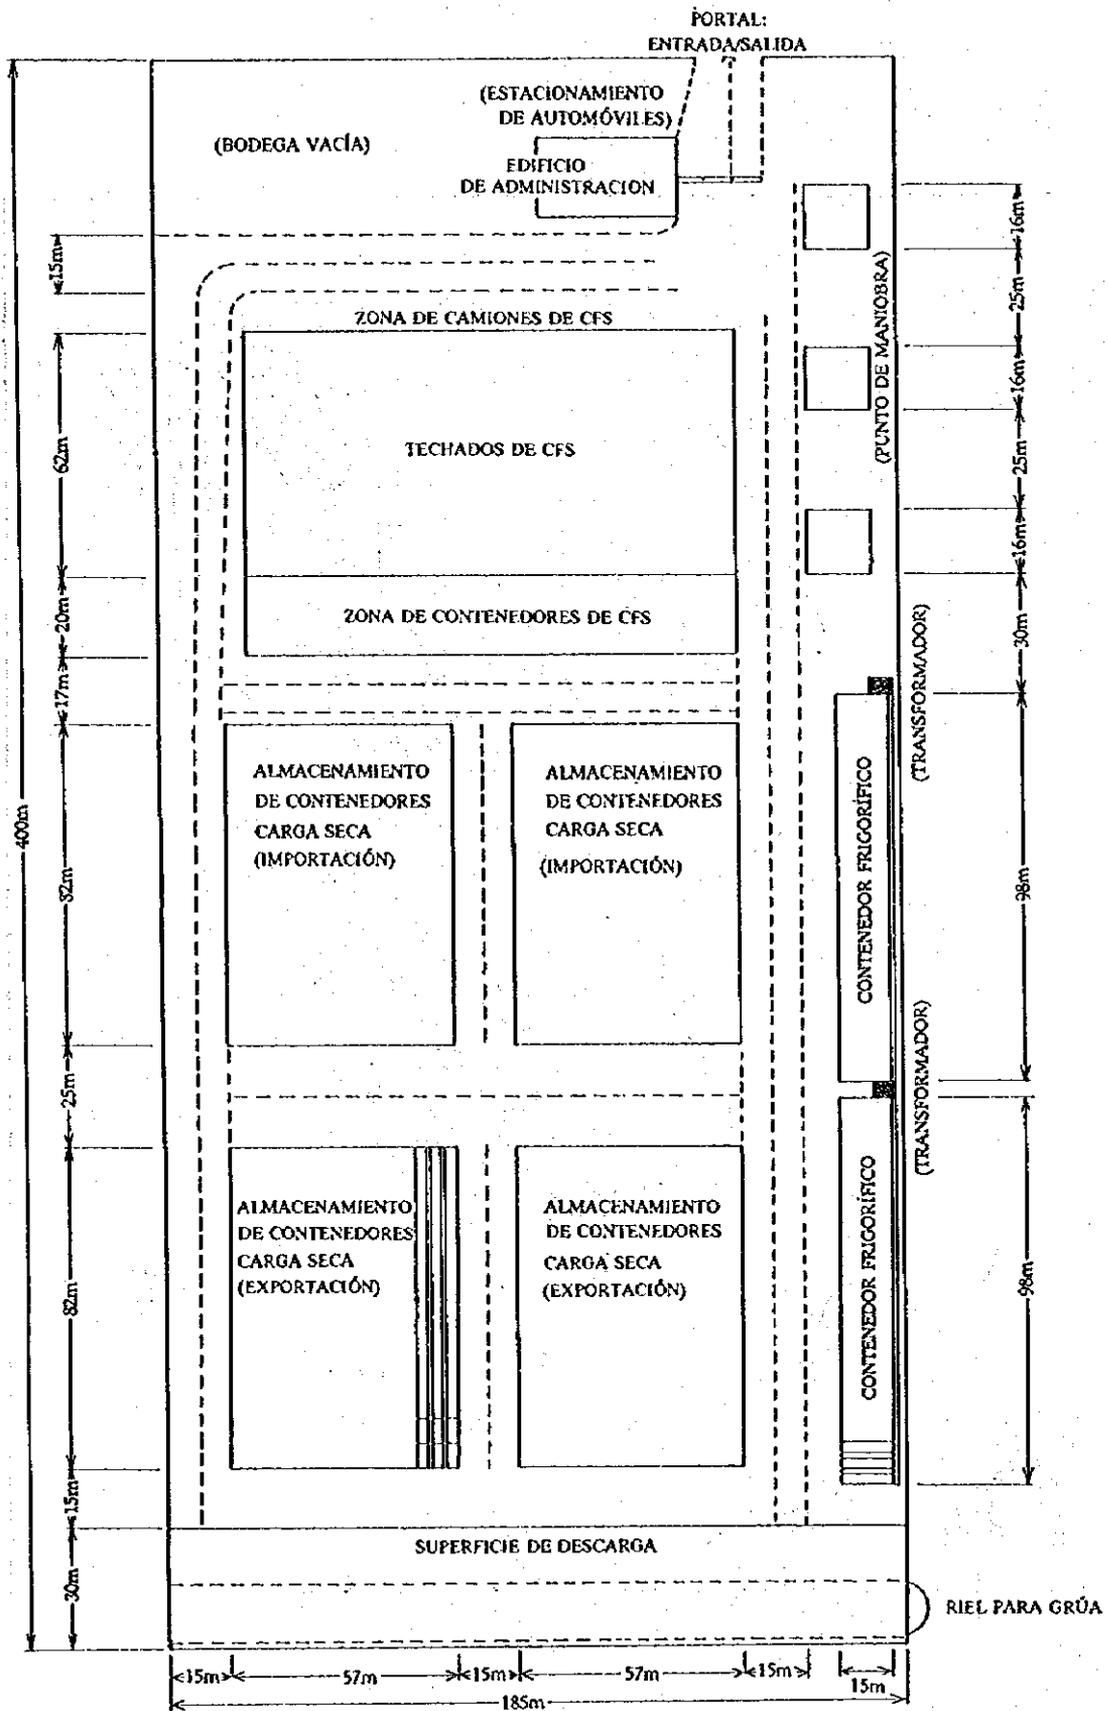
Plano de Disposición de la Terminal de Contenedores
